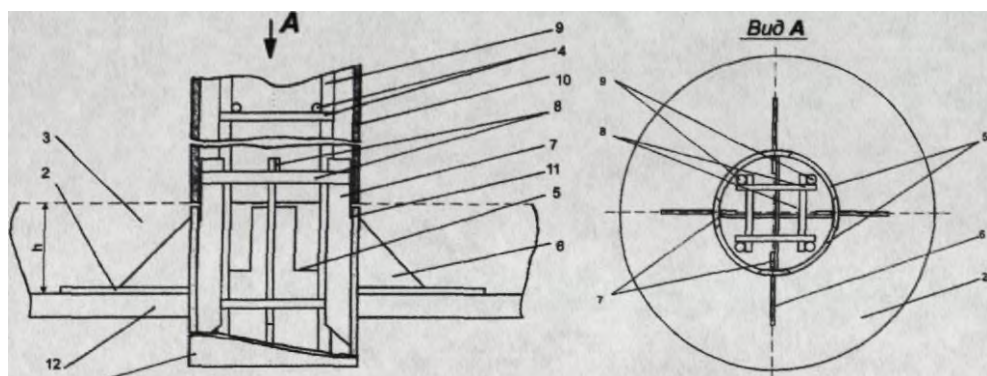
Вузол сполучення перекриття з колоною: 1 - колона; 2 - надколонна плита; 3 - плита перекриття; 4 - арматурний каркас колони; 5 -
